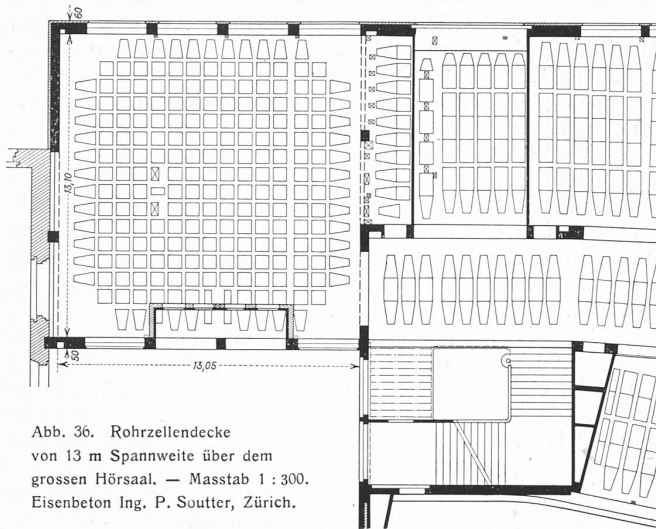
Rohrzellendecke von 13 m Spannweite über dem grossen Hörsaal. — Masstab 1 : 300. Eisenbeton Ing. P. Soutter, Zürich.
